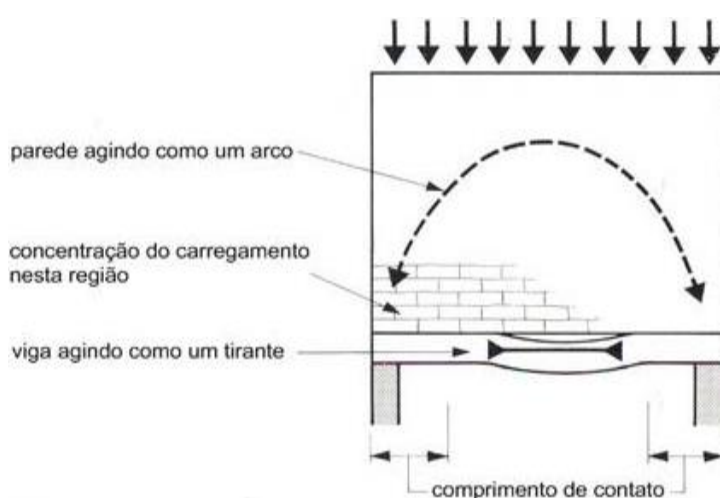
Ação conjunta do sistema parede-viga. Fonte: adaptado de Haseltine & Moore (1981).
